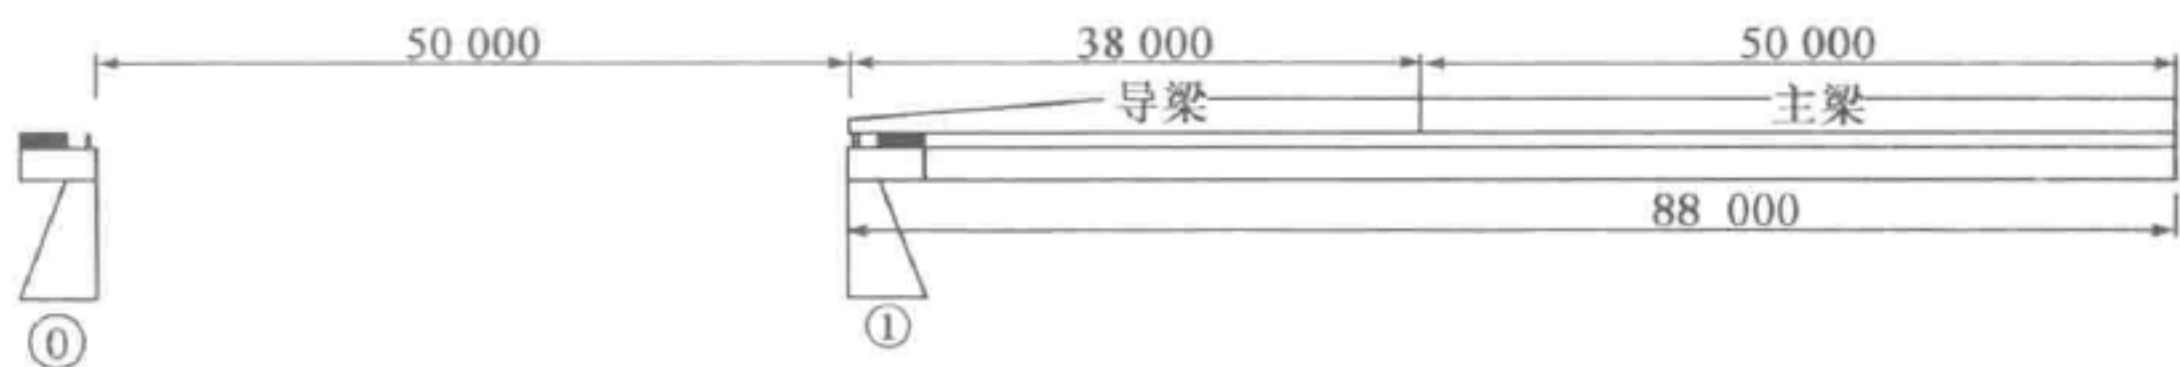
顶推立面布置示意图(尺寸单位:mm)
